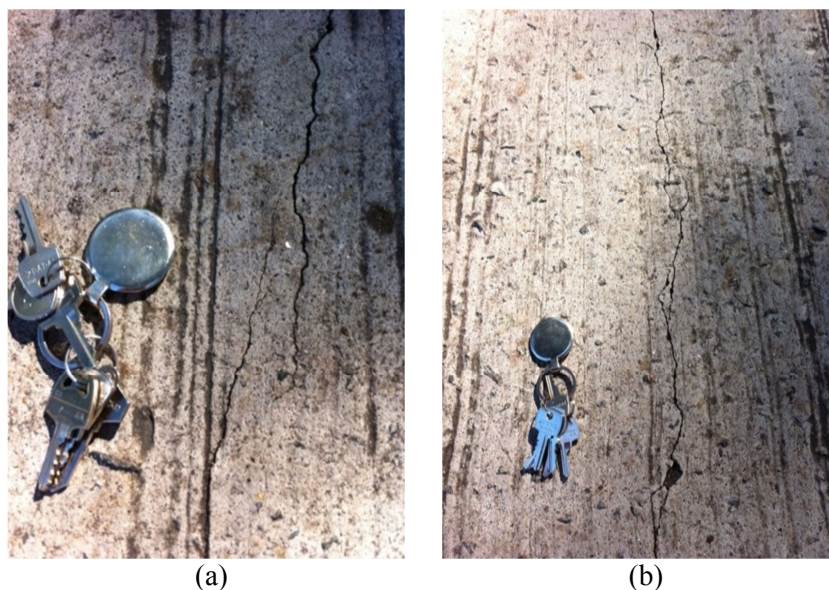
1 - Fissuras (a) divididas e (b) com indício de esborcinamento
